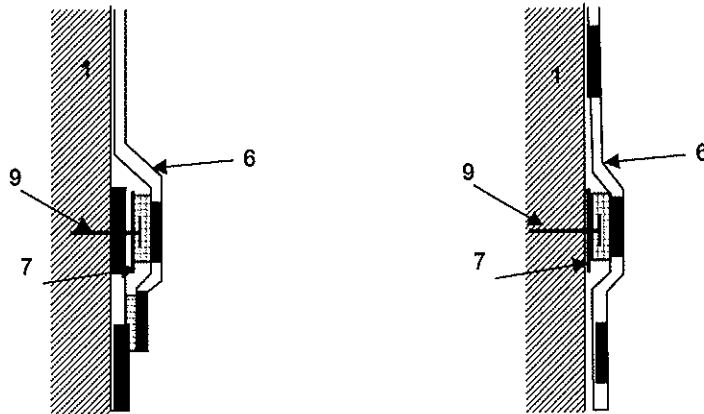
Relevés : recouvrements et soudures : dimensions à respecter
